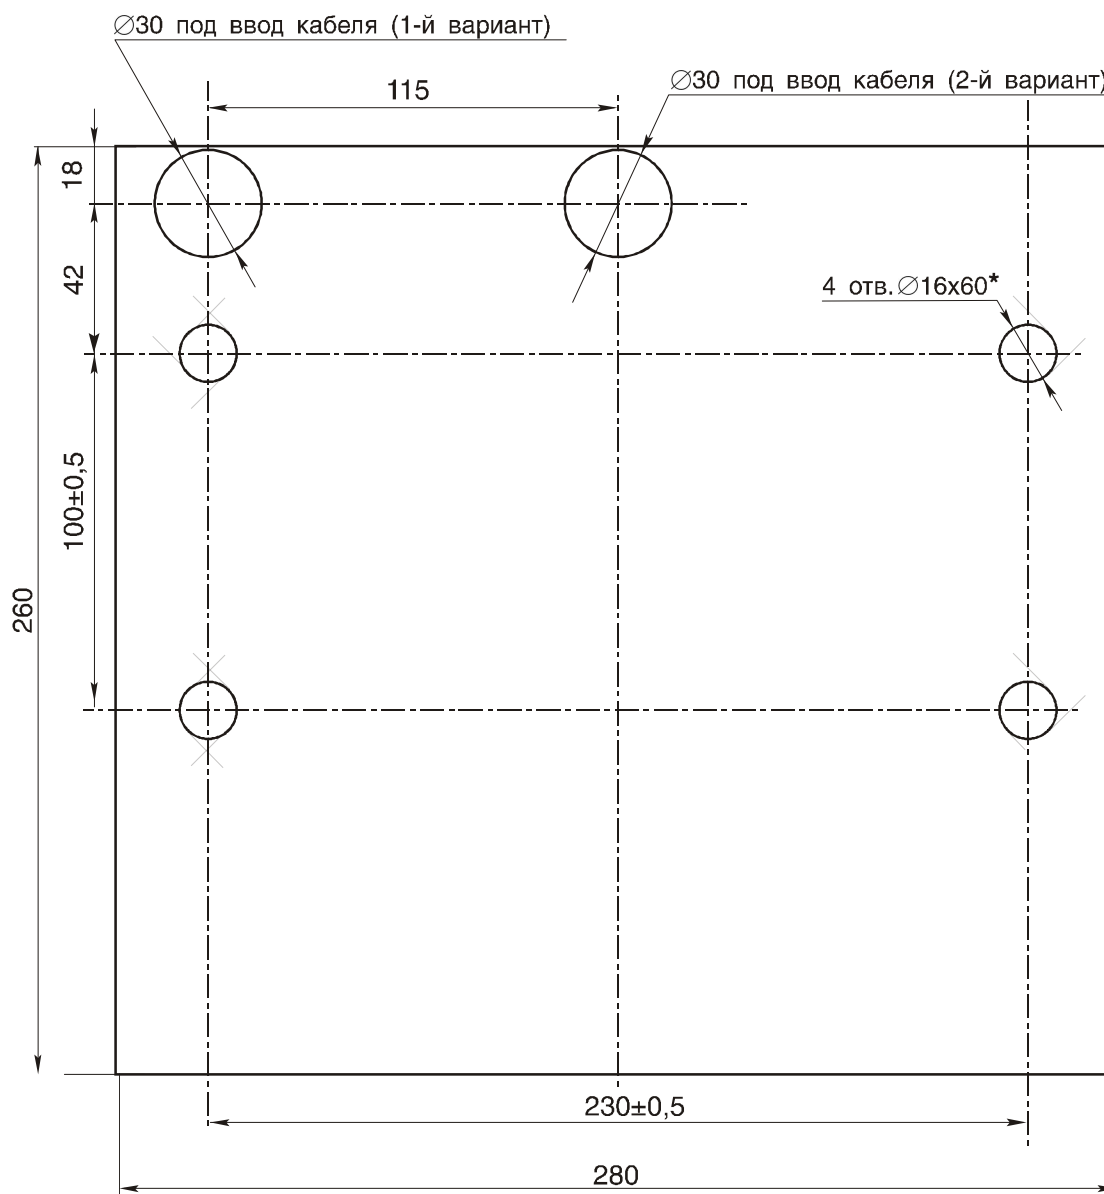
Разметка отверстий в полу под крепление стойки турникета PERCo-T-04 (PERCo-T-04W) и ввод кабеля
